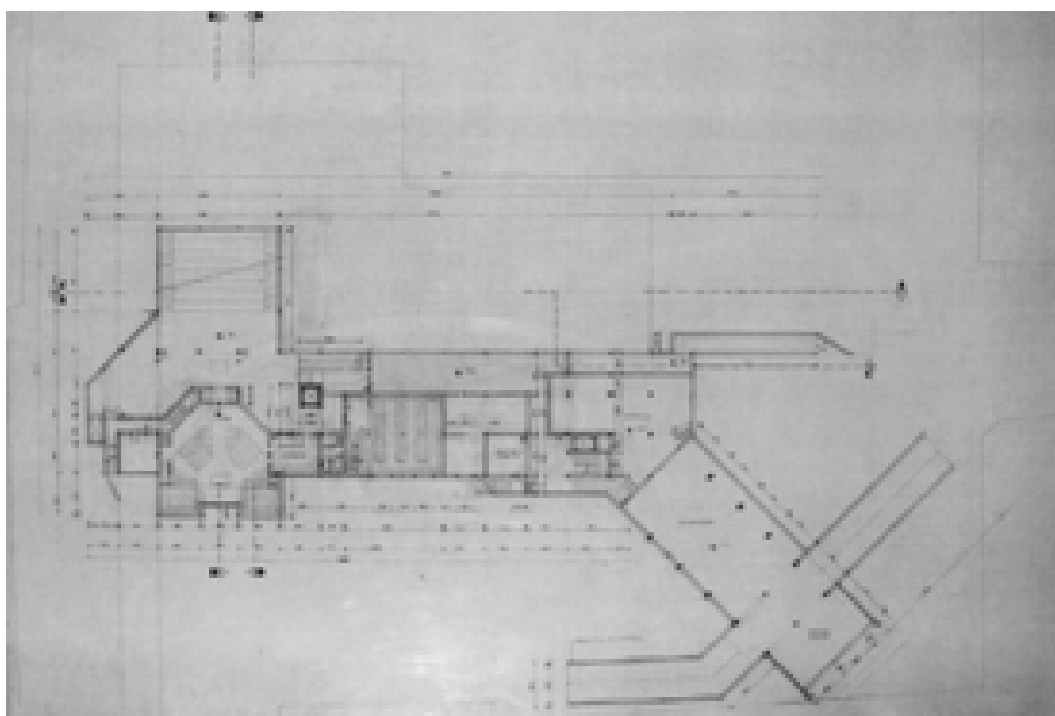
Pianta -2,70, stato futuro - 1989 (AABS-64_495)
